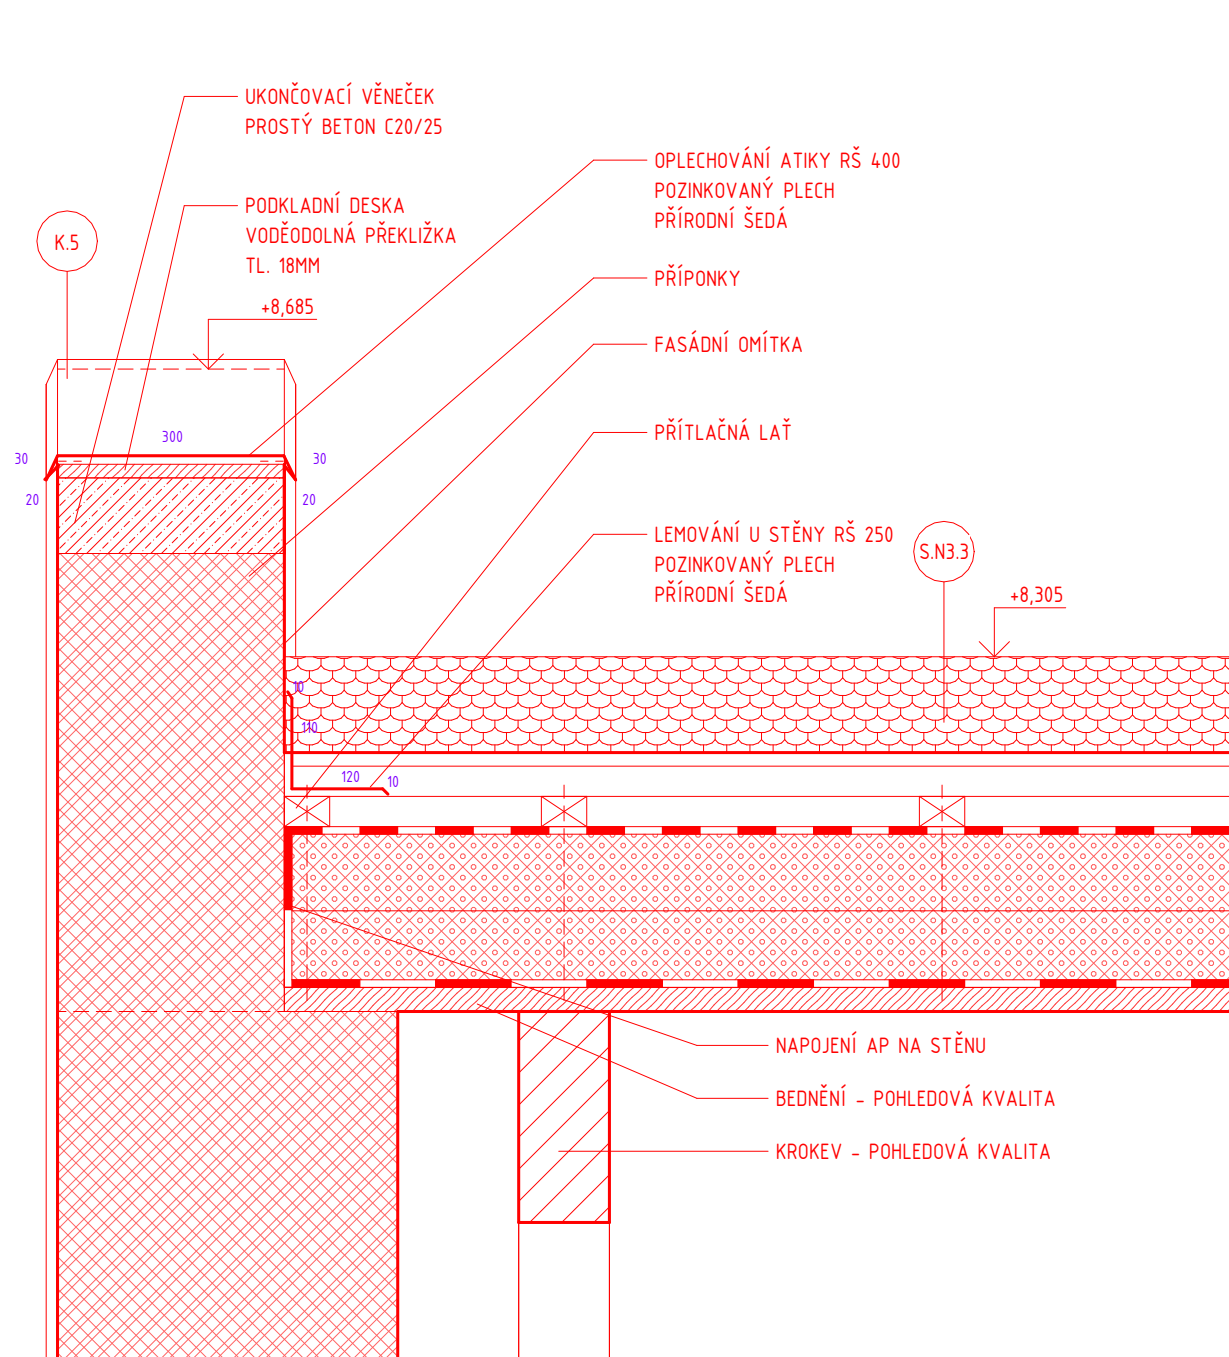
DETAIL E – ŘEŠENÍ U ČELNÍHO OKAPU
